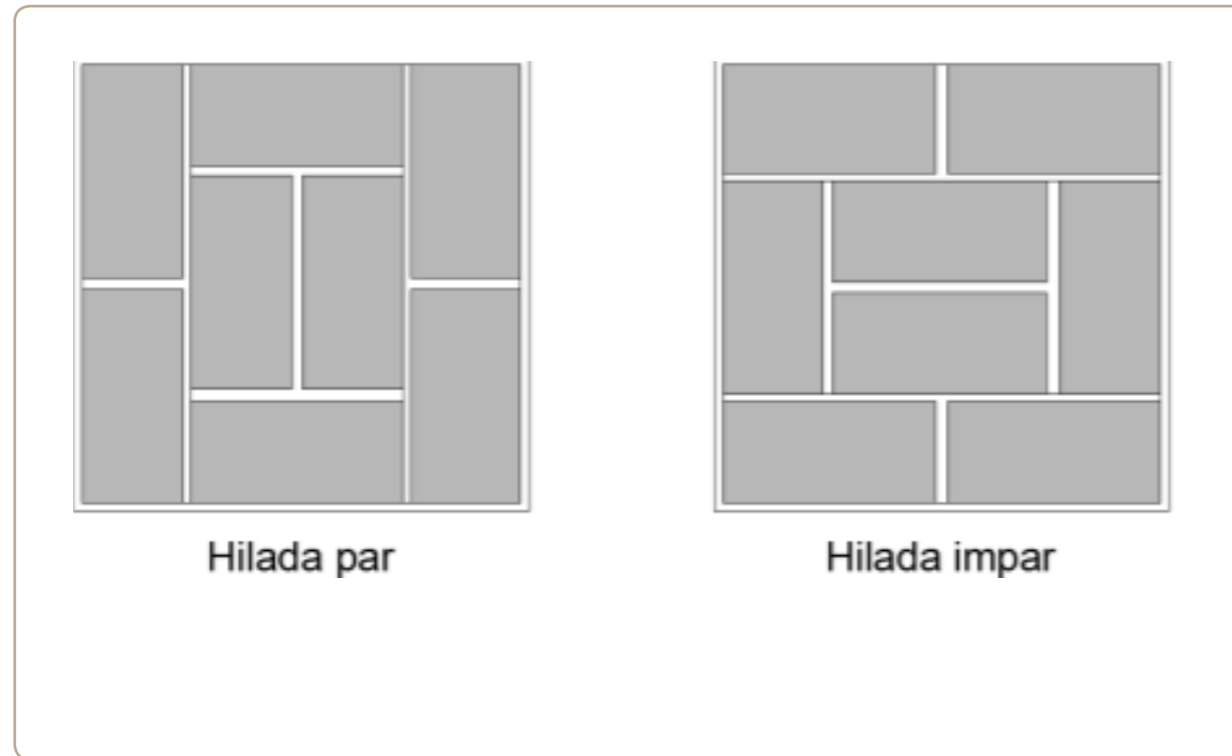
(Izquierda) Esquema planta de pilar de sección 52x52 cm en hiladas alternas.
